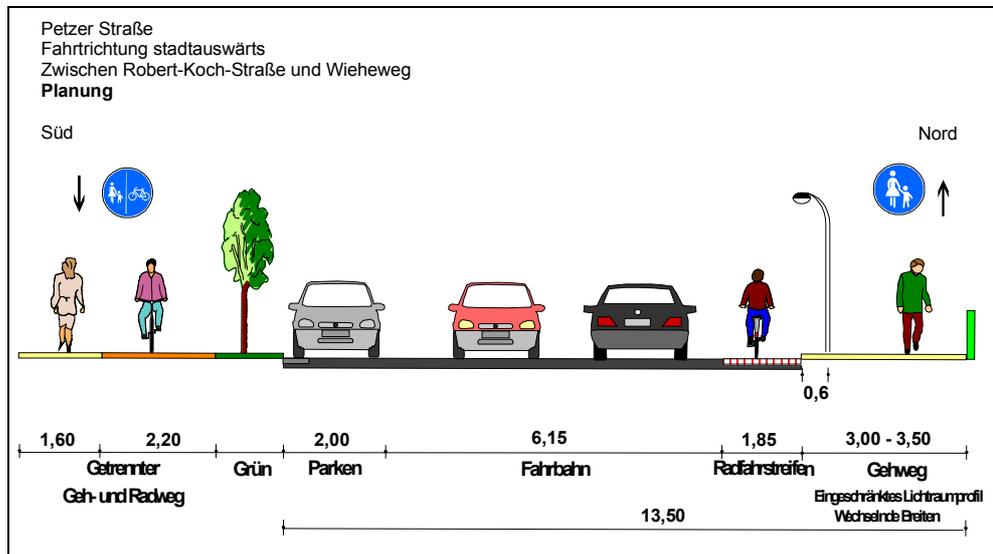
Querschnitt Petzer Straße, Robert-Koch-Straße - Wieheweg (Planung)
